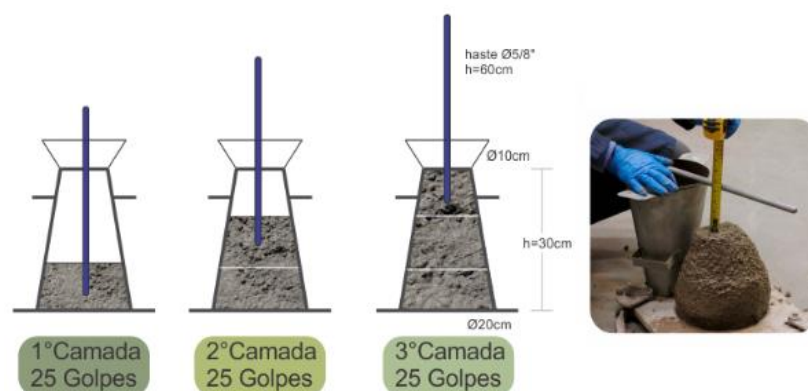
Slump test – Concreto sob ensaio de Slump durante a concretagem. – Fonte: <http://pedreiro.com.br/wp-content/uploads/2014/02/Slump-Test-Concreto.png>
